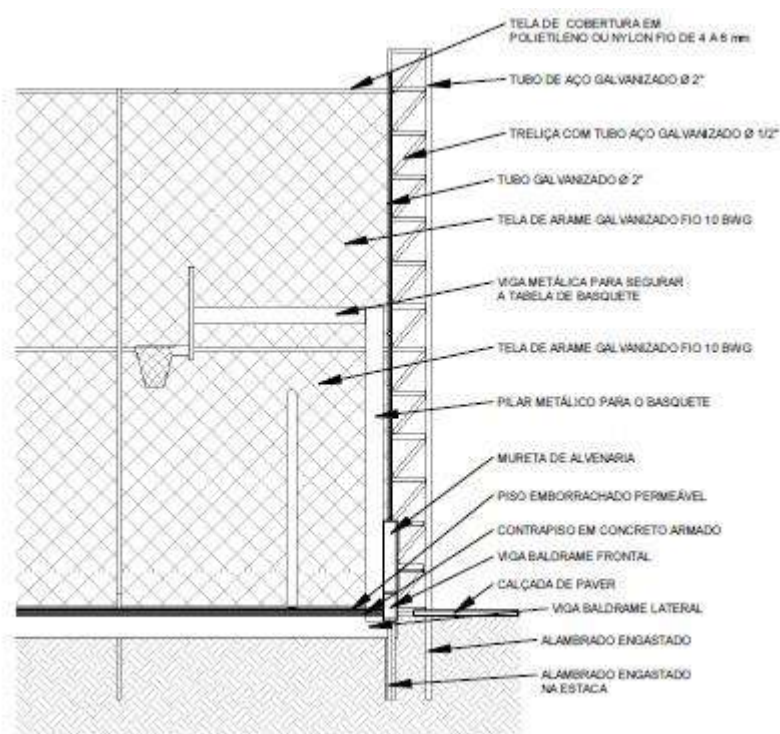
Detalhe de instalação do alambrado (Fonte: Autora/2022)
